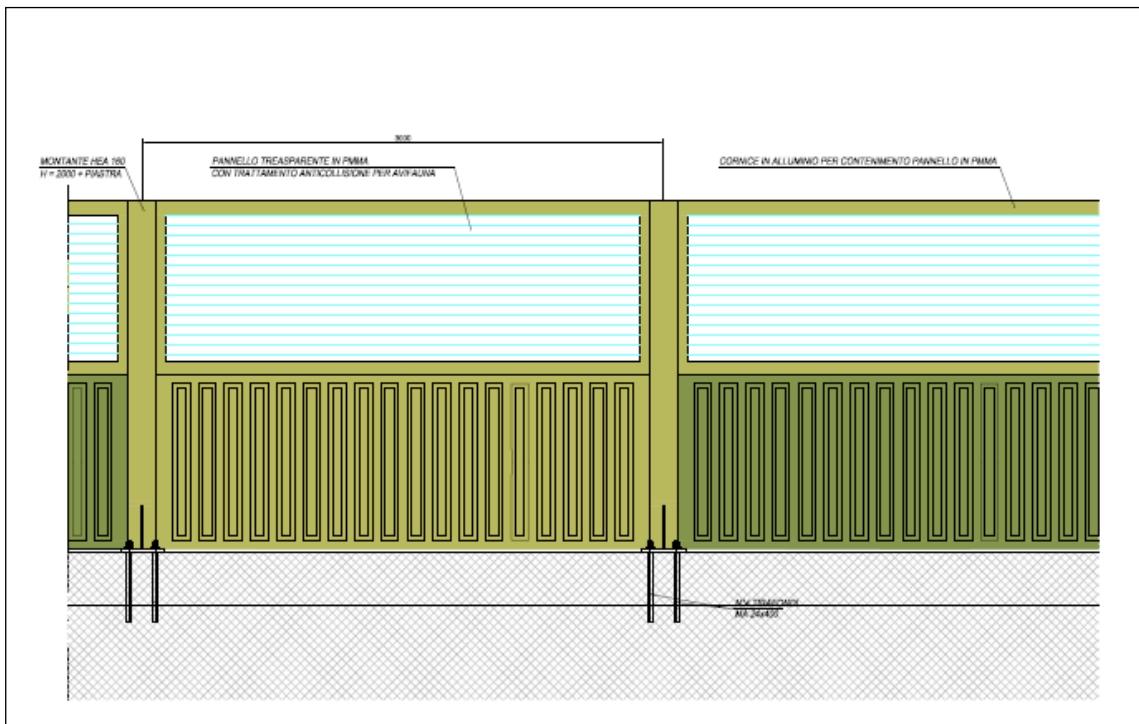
PROSPETTO TIPO BARRIERA H. 2 M SU DUNA
